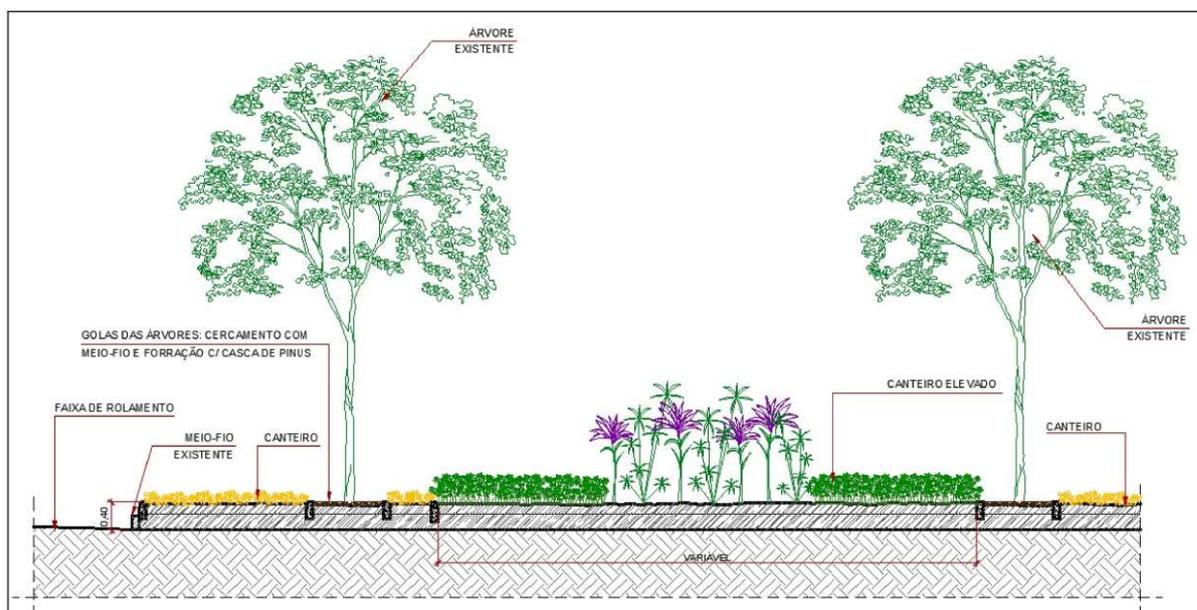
trecho em detalhe (seção longitudinal) de parte do canteiro com a elevação de área cultivada em trecho atualmente rebaixado (fonte: Serpenge)
